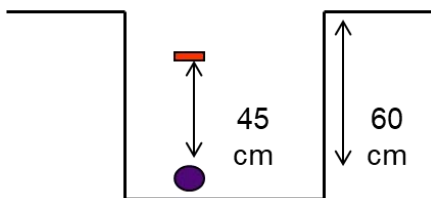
Tipos de Cable por tipo de instalación en planta externa. [6]
